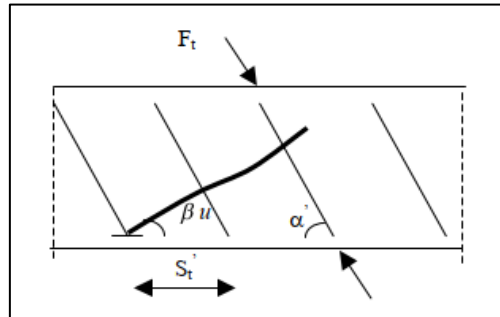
Angle des bielles d'une poutre en béton précontraint
